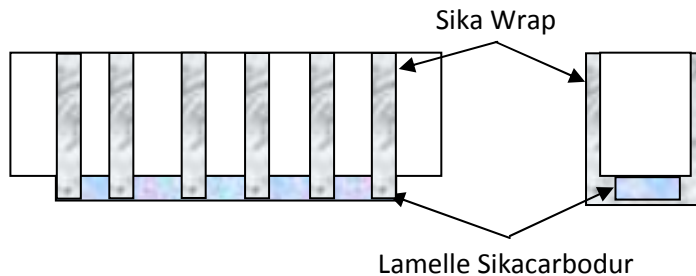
Renforcement en bandes aux faces latérales et lamelle en face inférieure[13]
